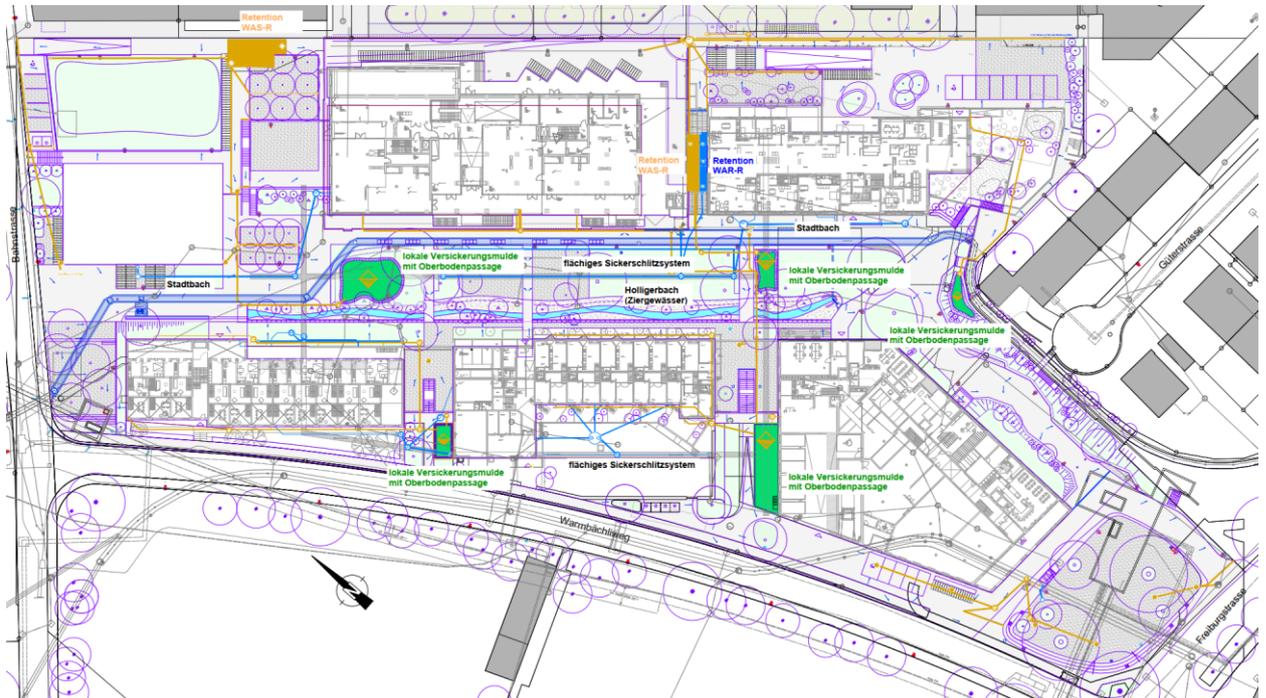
Grundriss der Liegenschaft inkl. Versickerungsmulden, Retentionen, Ziergewässer und Stadtbach
